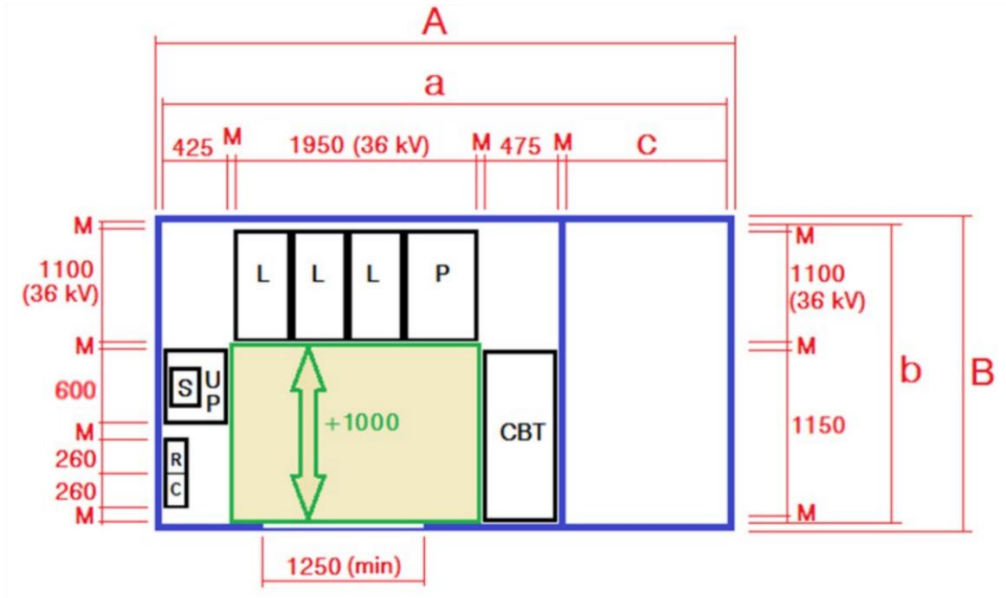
EP 3L1P 36 kV – Disposición 1 (cotas en mm)
